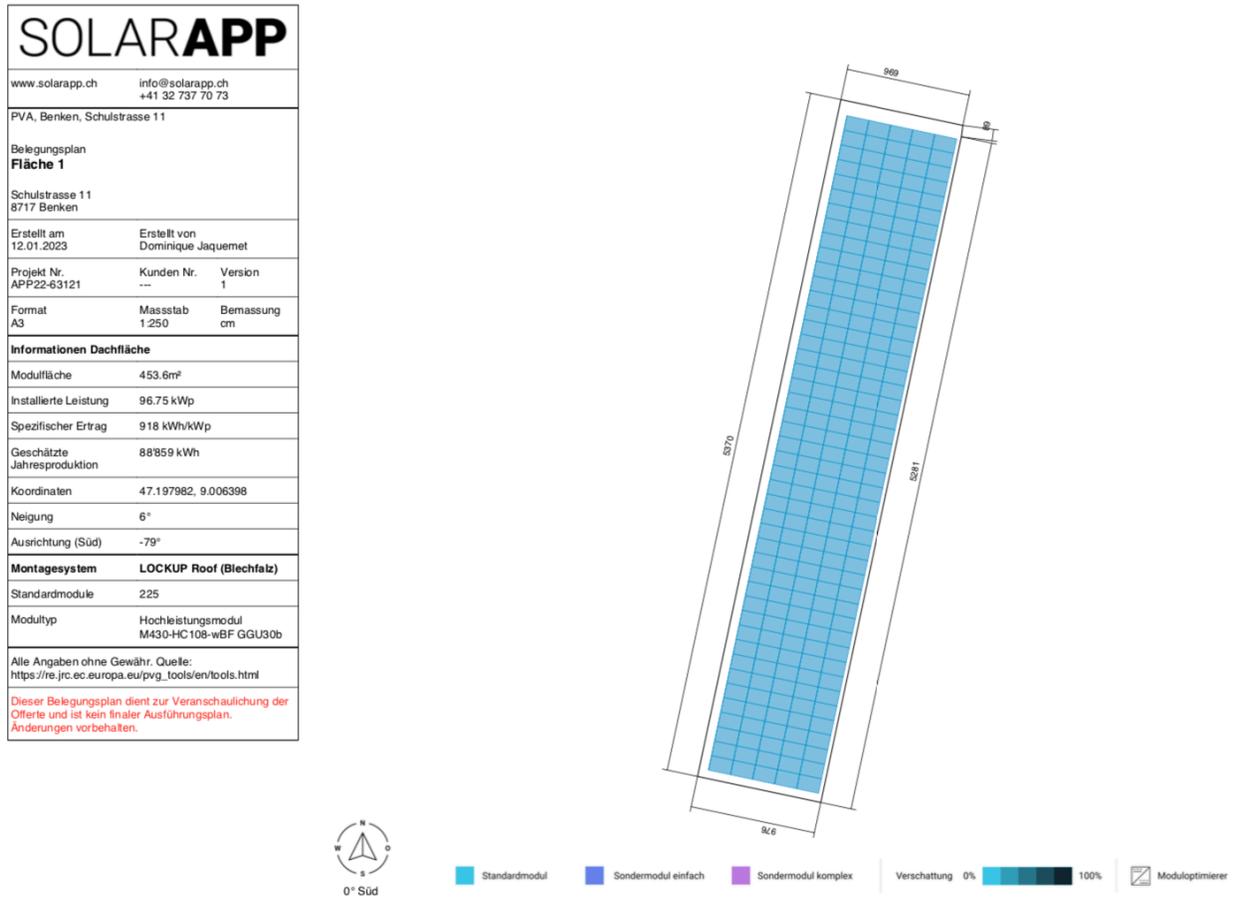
Schulstrasse 11, Belegungsplan der westlichen Dachfläche
